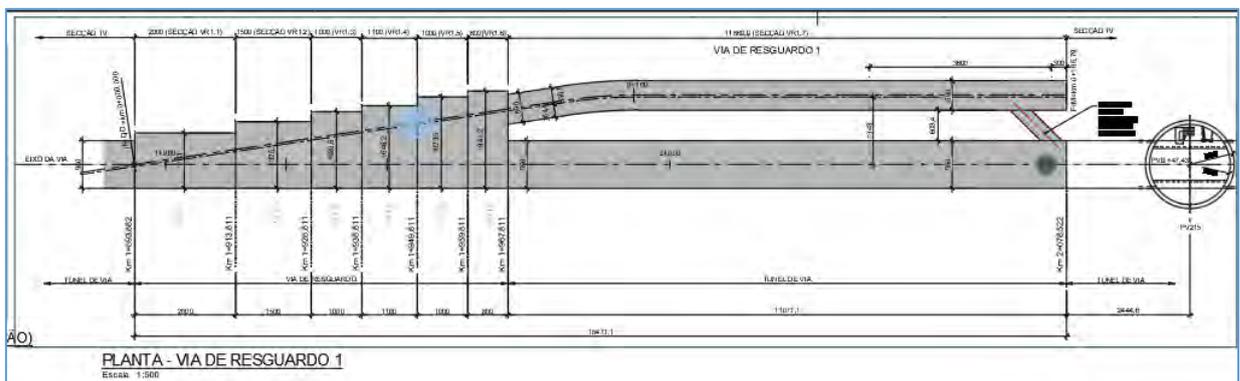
Definição da Via de Resguardo 1. Planta de implantação
